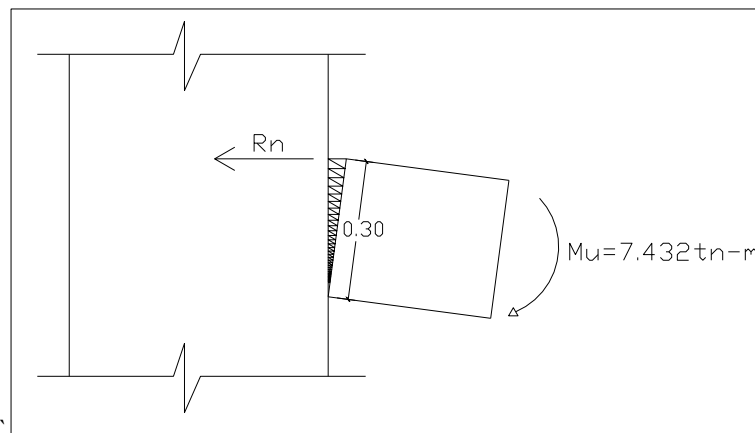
Esfuerzos actuantes para el diseño de la soldadura del ala superior.
